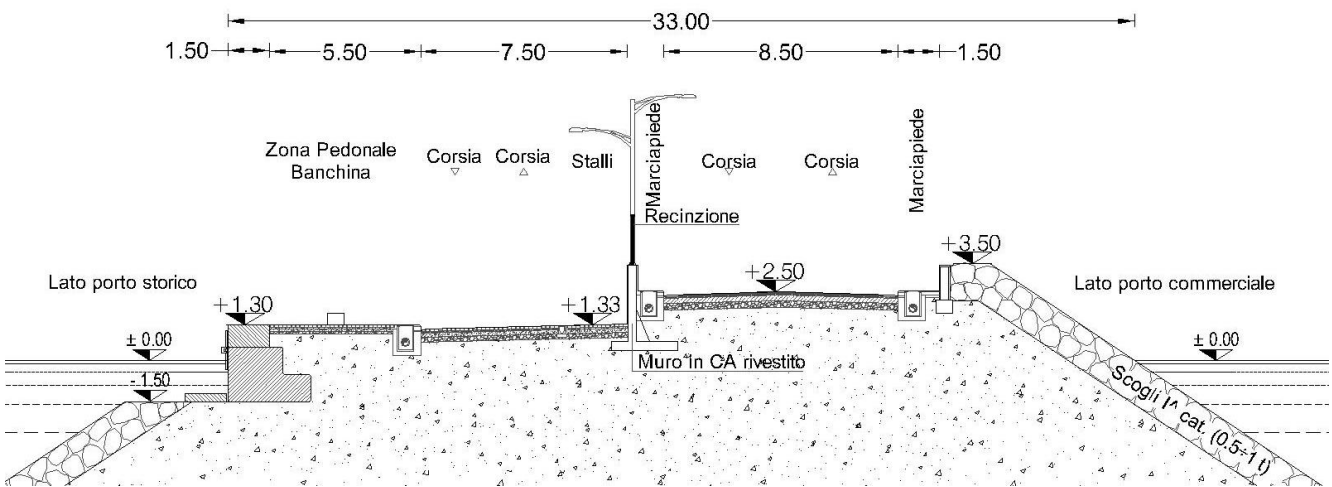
Sezione tipo del nuovo collegamento. Organizzazione della sovrastruttura
